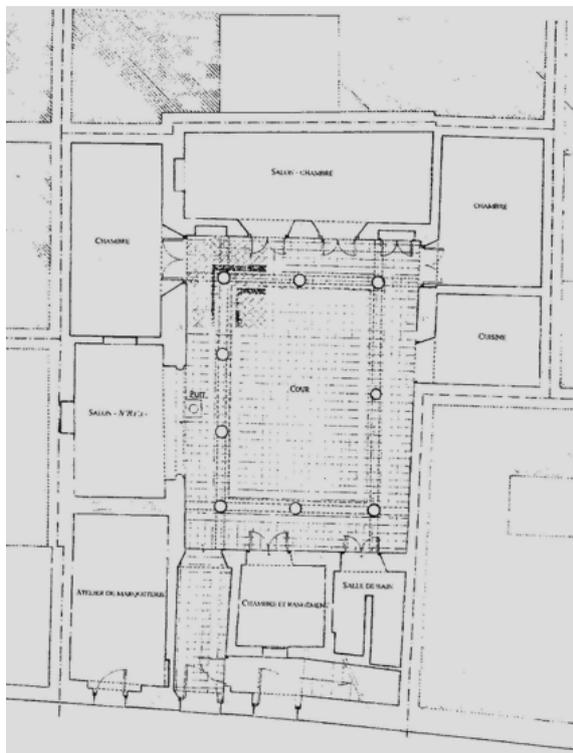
Grundriss des Hauses Dar Bachar
